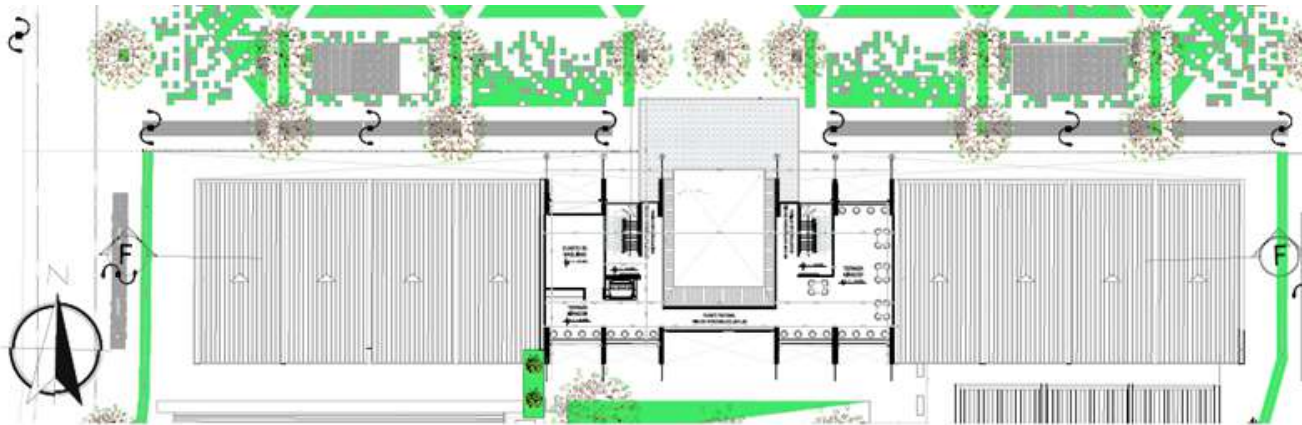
planta arquitectónica 4° piso y sótano Fuente: elaboración propia.
